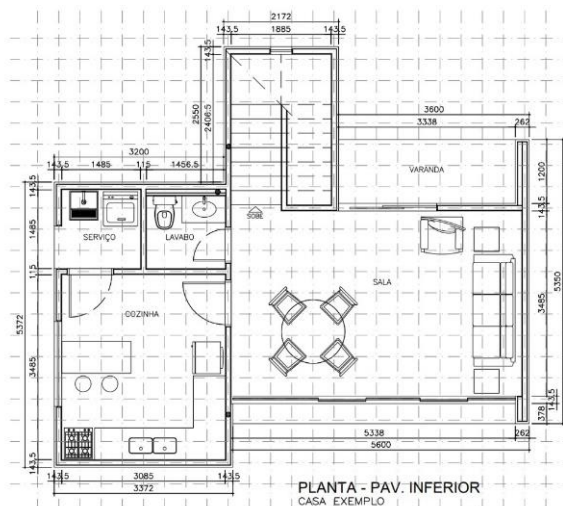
Planta do pavimento inferior com a introdução da malha modular
